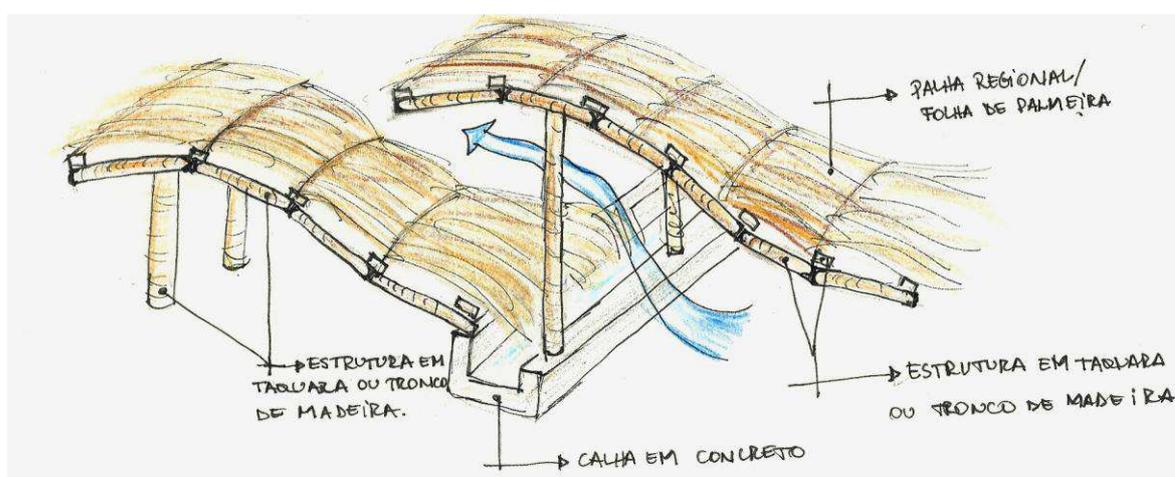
Croqui de telhado com shed alternativo - Estrutura em taquara e fechamento em palha.
